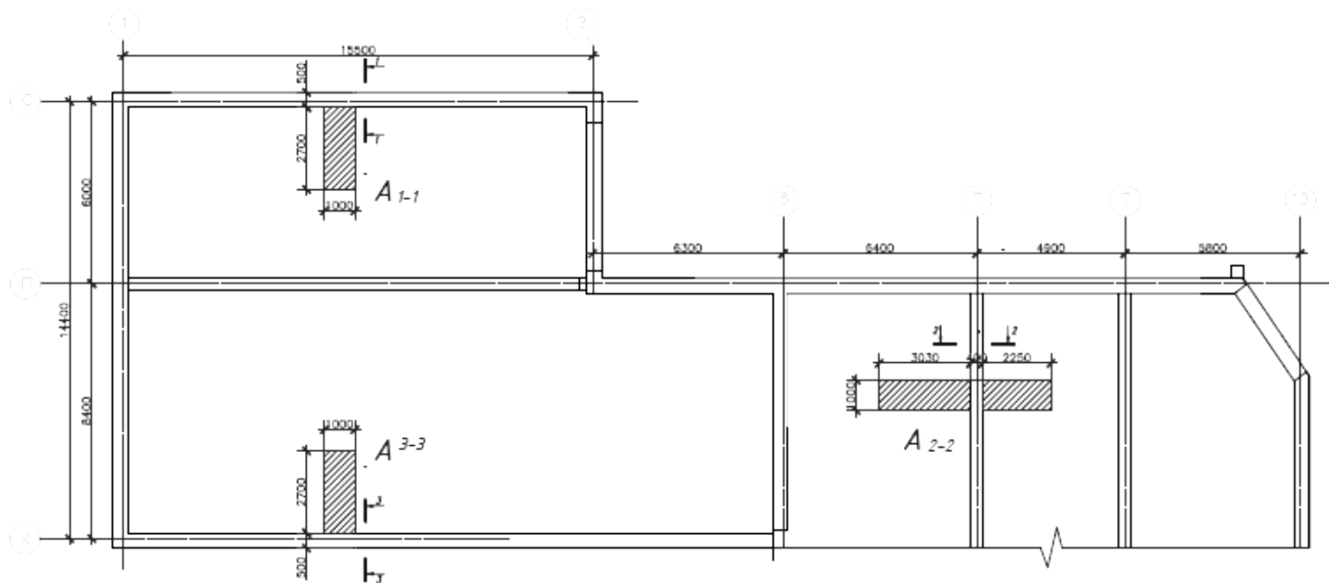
Визначення навантаження від перекриття для розрахунку фундаментів
